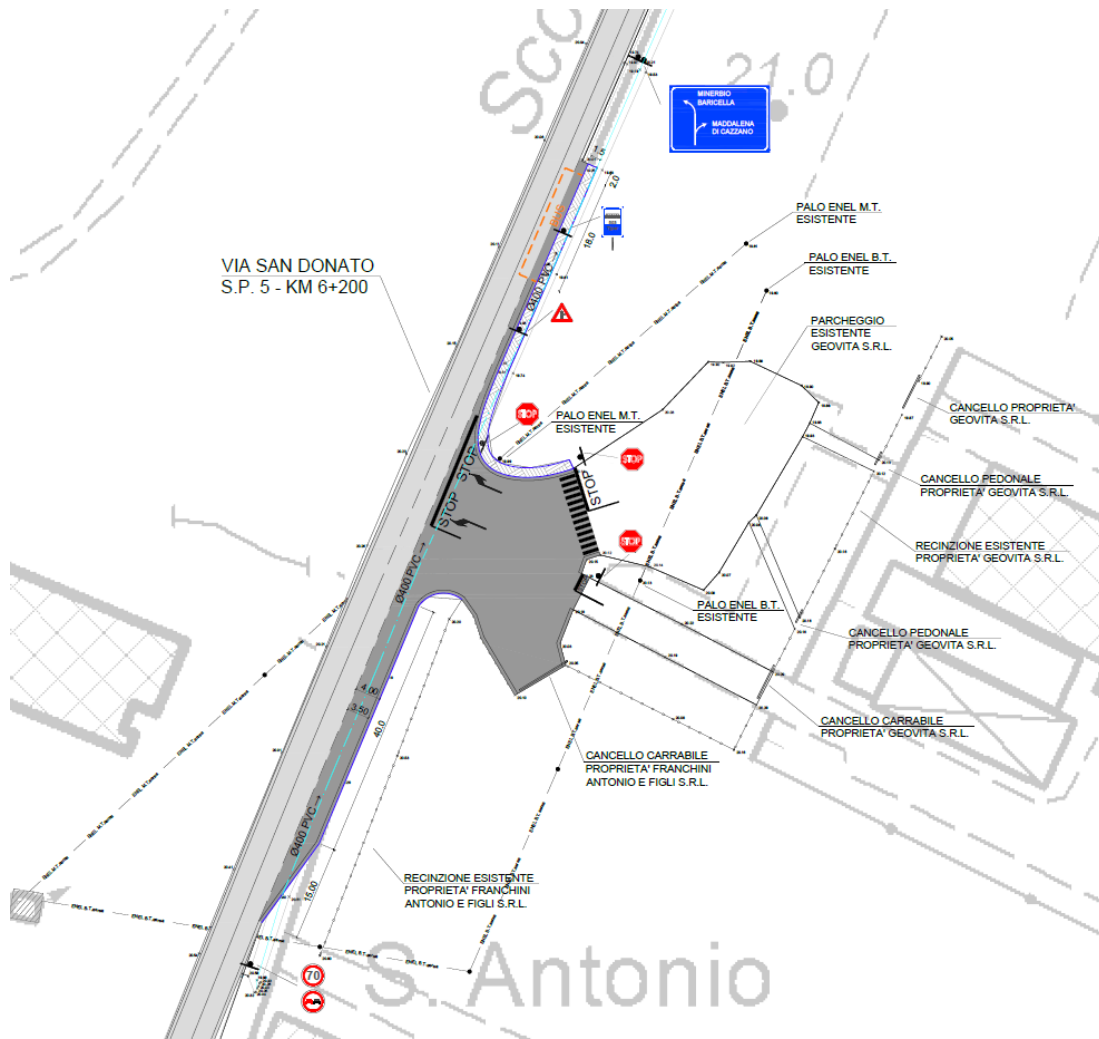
Planimetria segnaletica di progetto dell'accesso all'area
